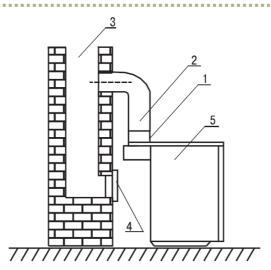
Примерная схема подключения котла к кирпичному дымоходу 1. Дымоотводящий патрубок котла; 2. Соединительный патрубок; 3. Дымоход; 4. Дверца для чистки; 5. Котел.
